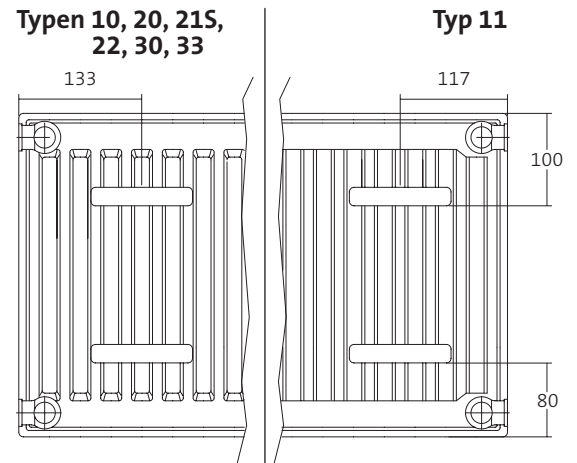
Laschenmaße für Compact mit Befestigungslaschen (Rückansicht)
